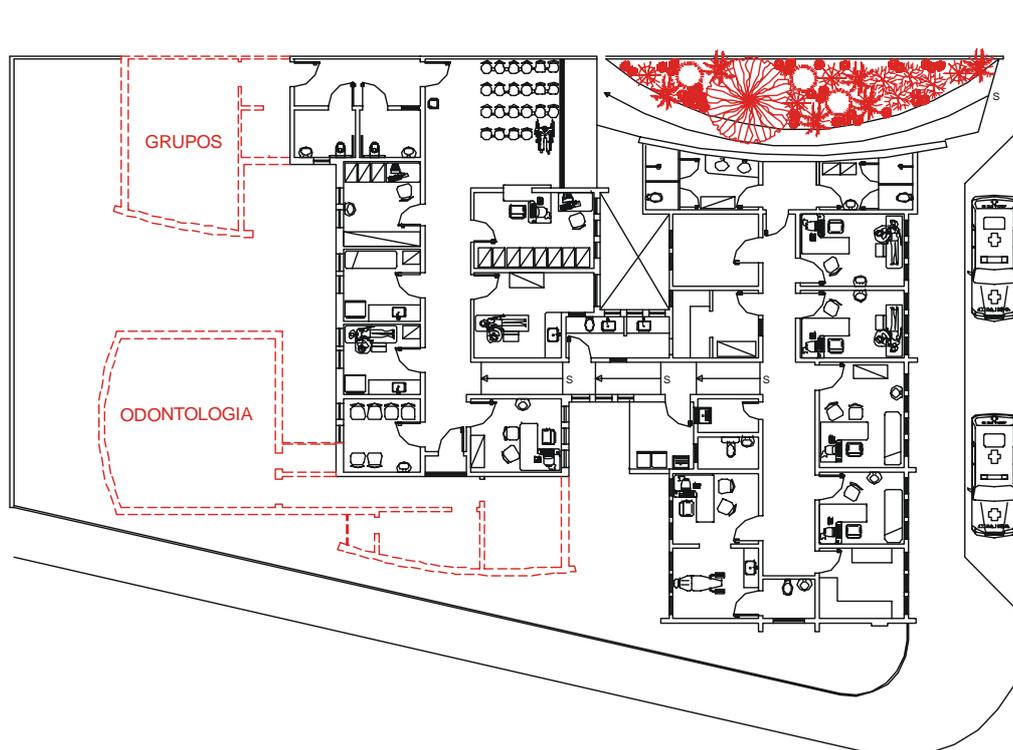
Planta baixa da atual UBS Milho Branco.
